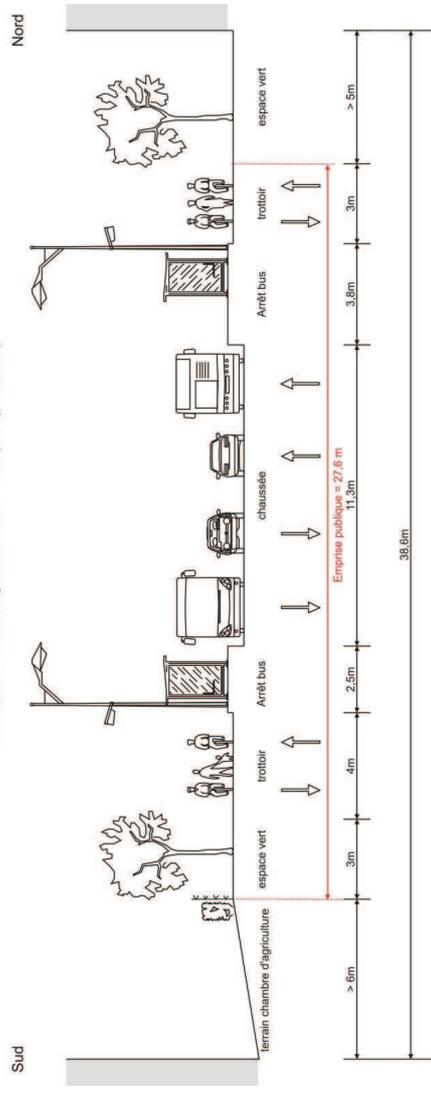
Situation existante (coupe 12) route de Hausbergen, station "Europe"
